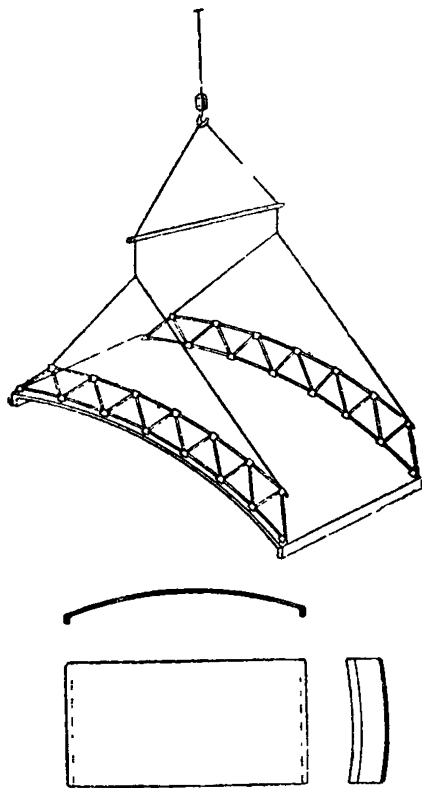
Монтаж крупноразмерных элементов, не подкрепленных по контуру ребрами
